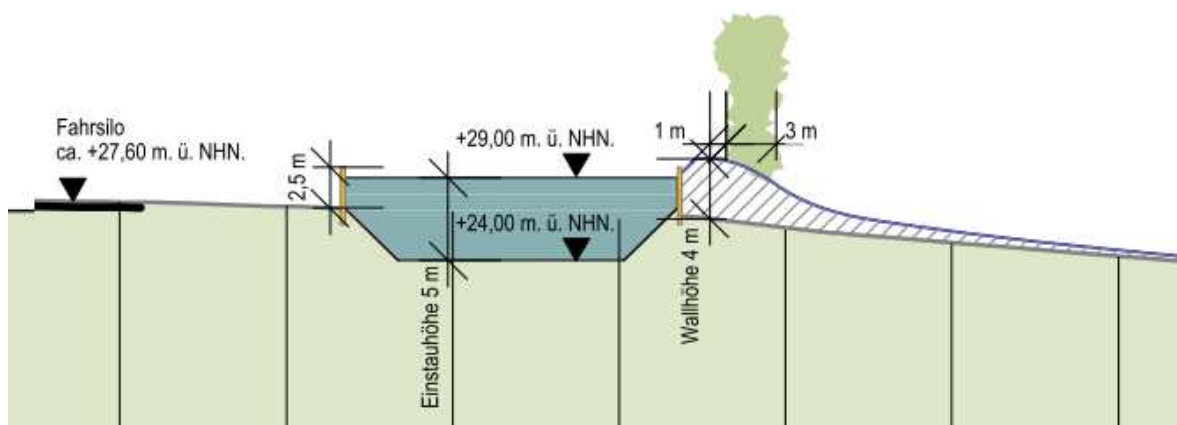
Systemschnitt zur Alternative Volumenerweiterung Regenklärbecken
